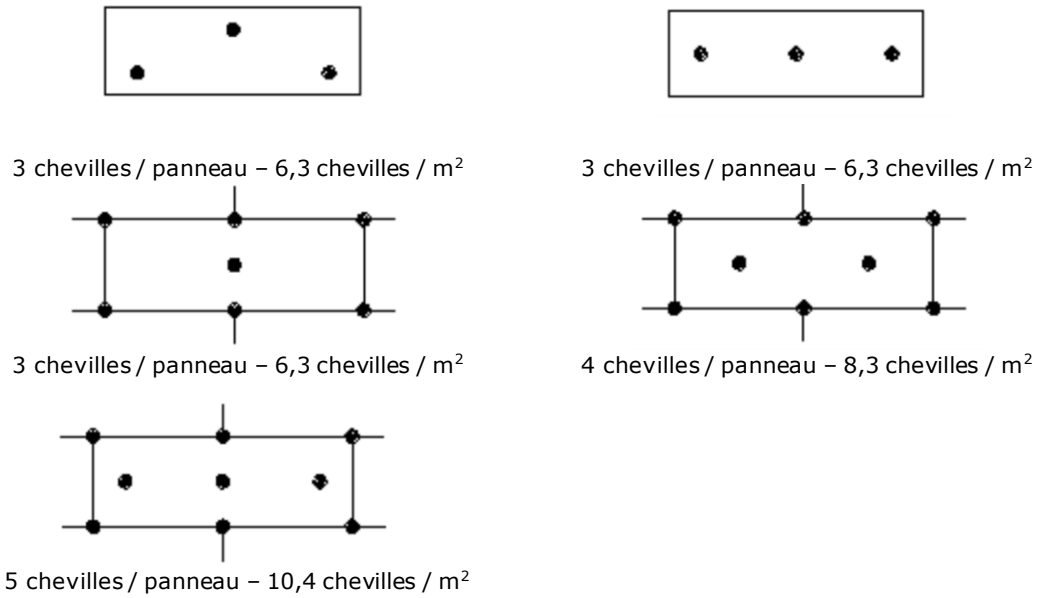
Panneaux FKD-MAX C2 de dimensions 1200 x 400 mm – plans de chevillage « en plein et en joint » (espacement entre chevilles ≥ 150 mm)
